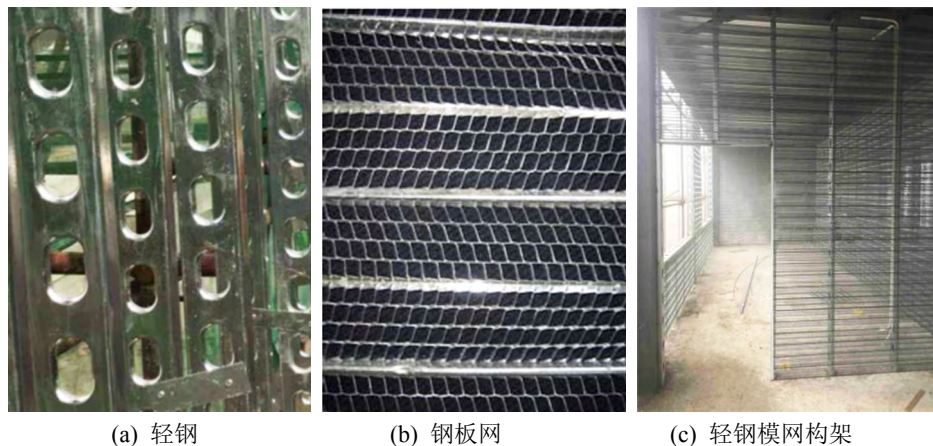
轻钢模网改性聚苯颗粒混凝土复合墙体
